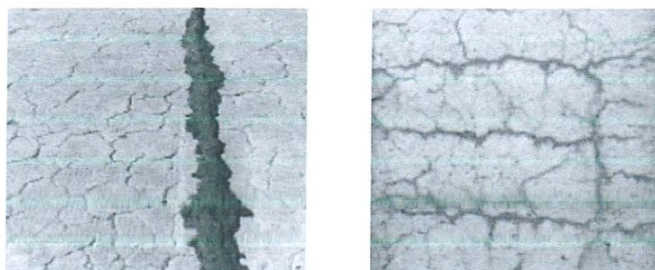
Fissuration par l'expansion du béton
